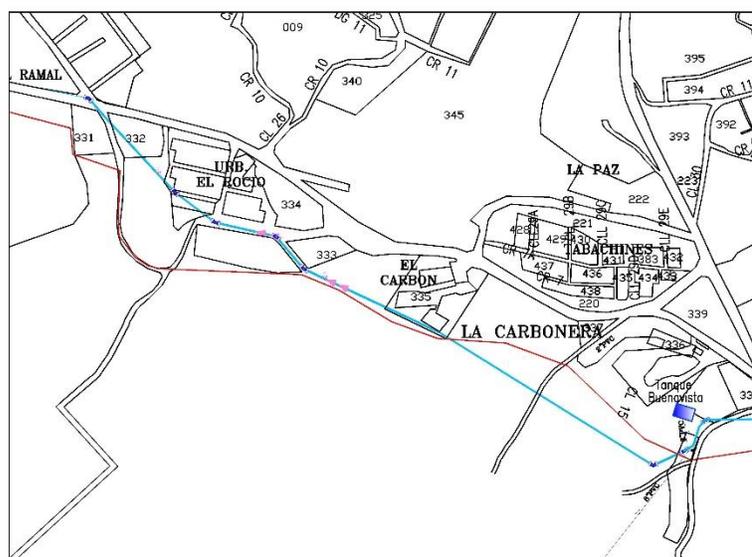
Localización en planta de la tubería de conducción tanque Buena Vista- Ramal.
